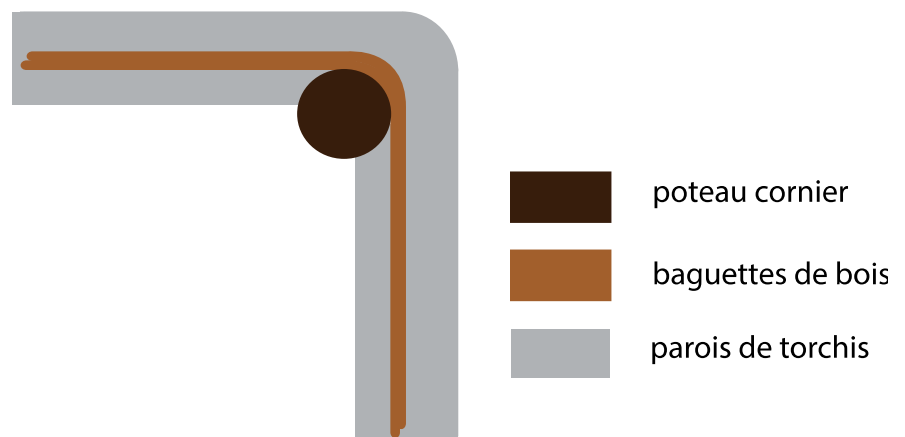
Essai de restitution d'un angle de mur en clayonnage – vue en coupe longitudinale (d'après F. 1301-2 – sd. 352, planche no. 1)
